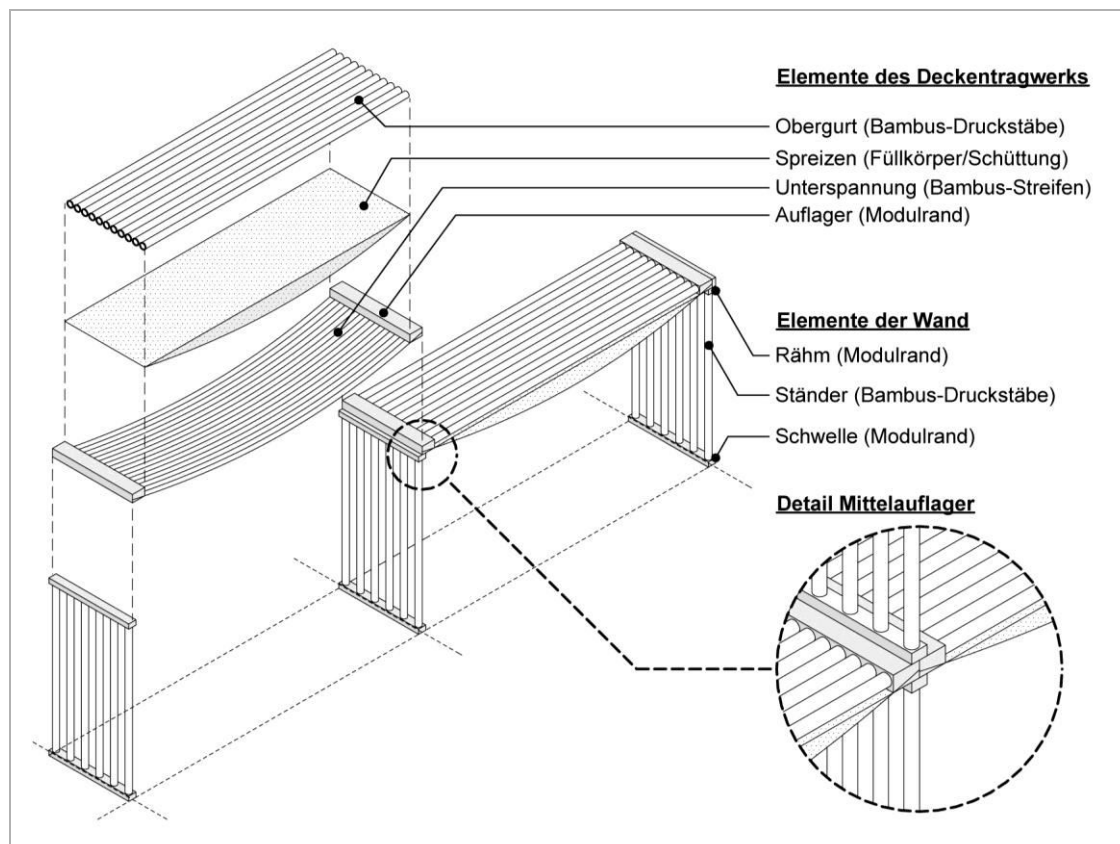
Konstruktionsprinzip einer mehrgeschossigen Bauweise aus Bambus.
